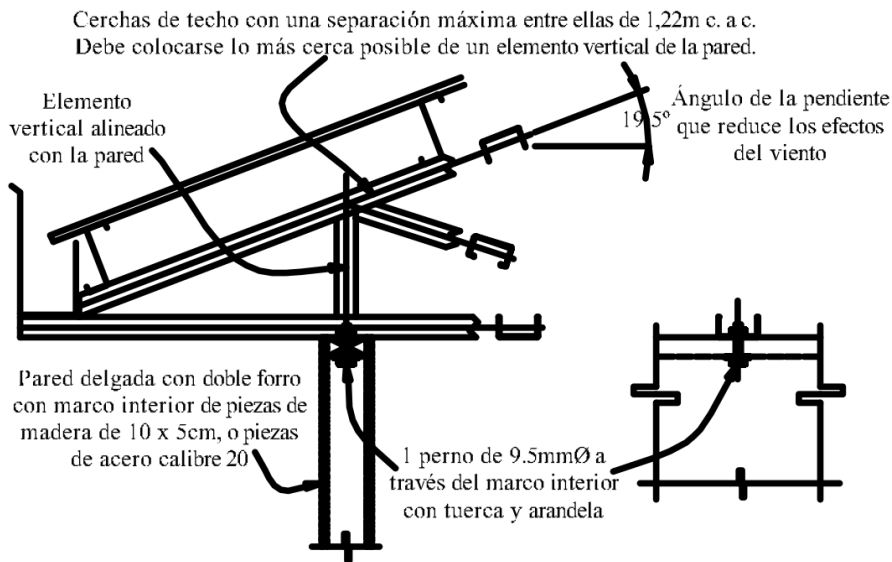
Detalle de apoyo de cercha en pared tipo emparedado
